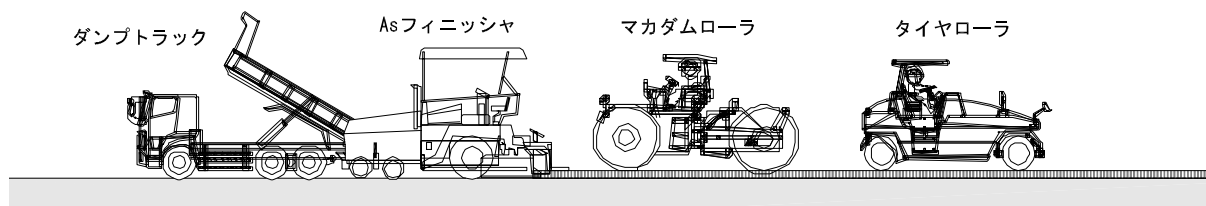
半たわみ舗装（表層）の施工状況
